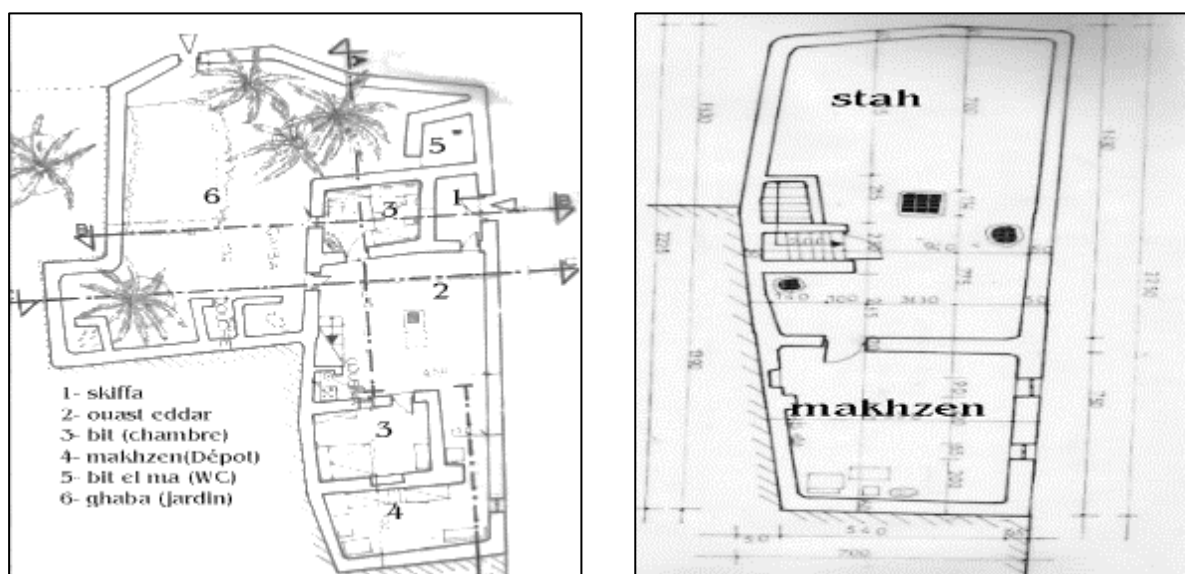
Une maison traditionnelle Zibanaise, Région de Biskra (Plan du RDC à gauche et plan de l'étage à droite)
